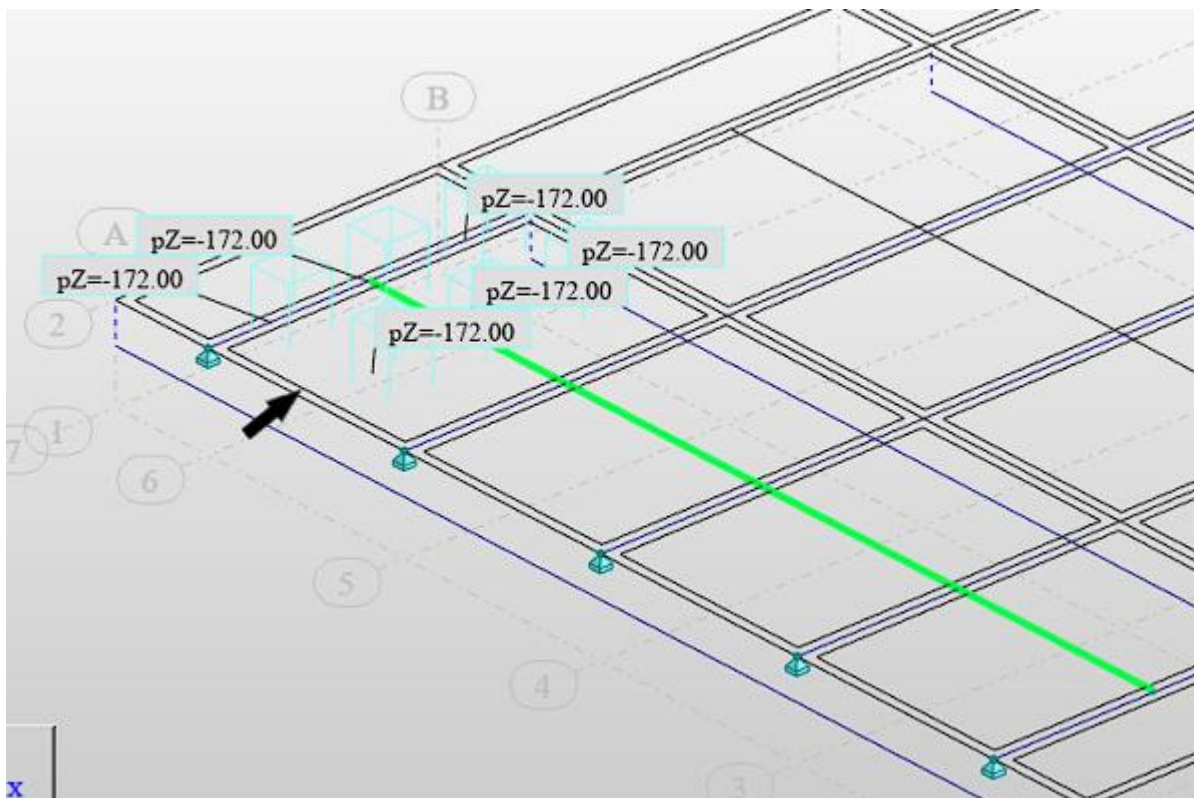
Aplicação de carregamento do veículo para análise da laje L2, ponte 2
